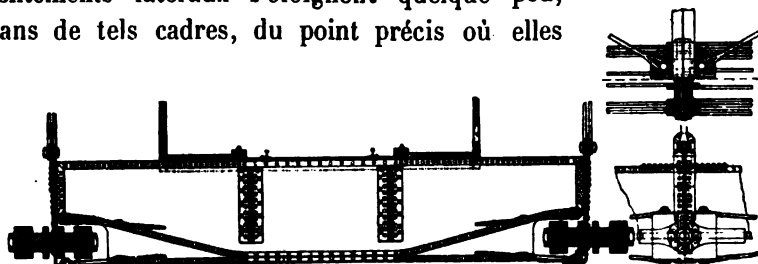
Pont de l'Ohio Connecting Ry. Tablier et contreventement.
